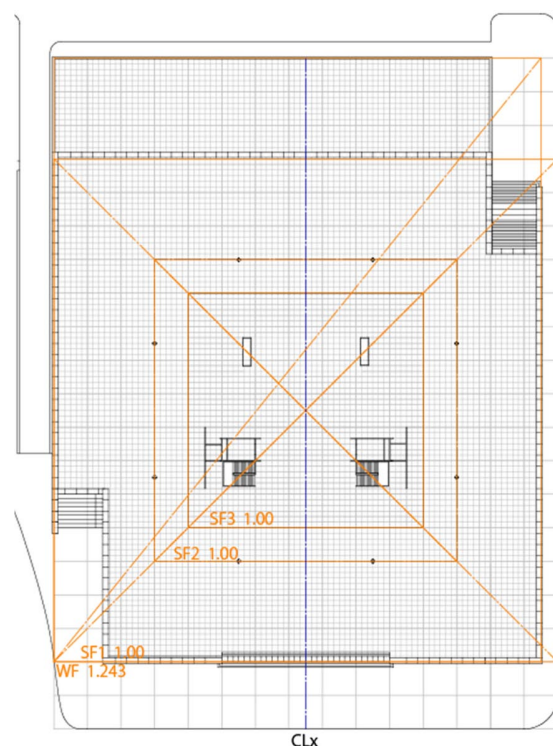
ニュー・ナショナル・ギャラリー 1 階平面図
